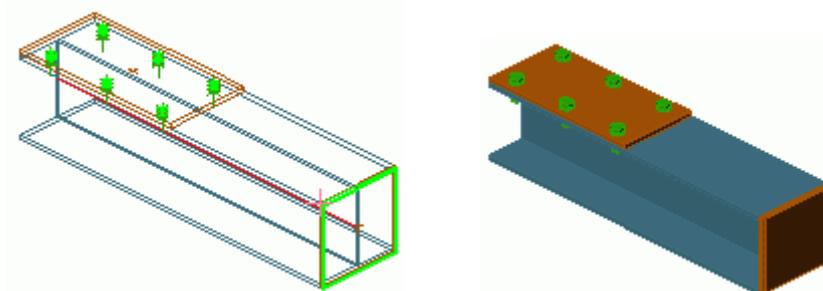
Groupe de boulons, Point de Soudure
